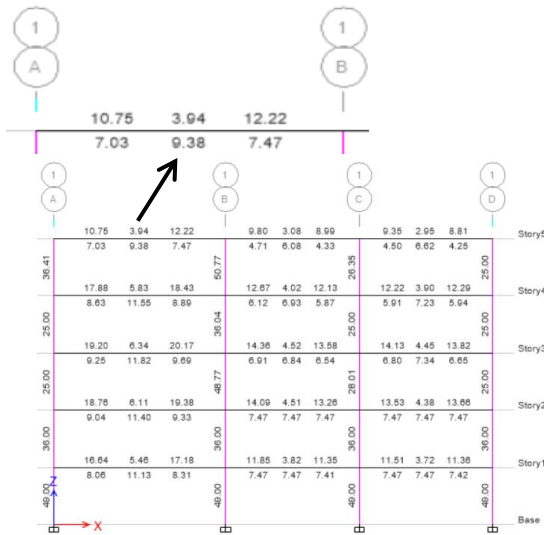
ETABS Área de acero de refuerzo en columnas del edificio de hormigón alternativo
